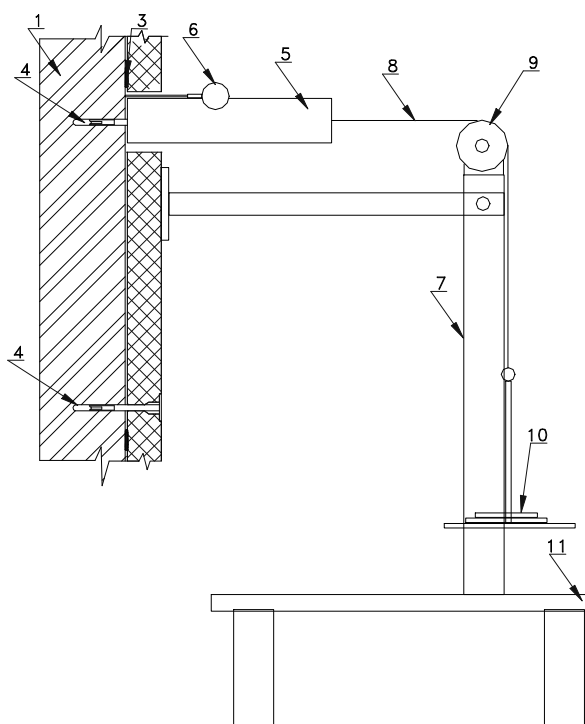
Схема испытаний на выдергивание из стен здания анкеров:
